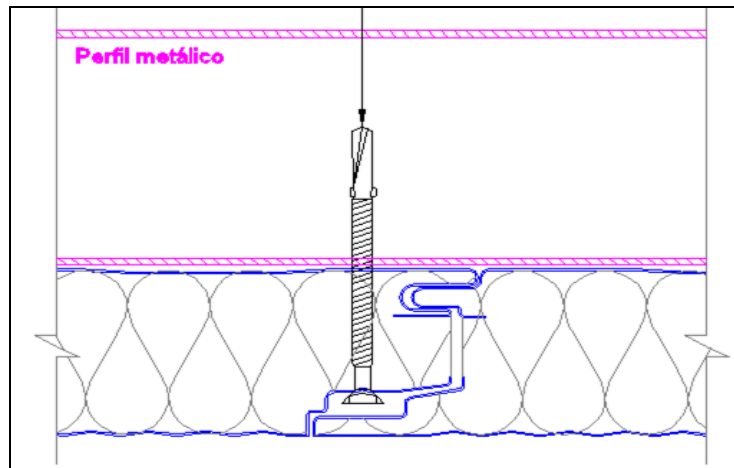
Ligação das placas ISOJOINT nos perfis metálicos.
